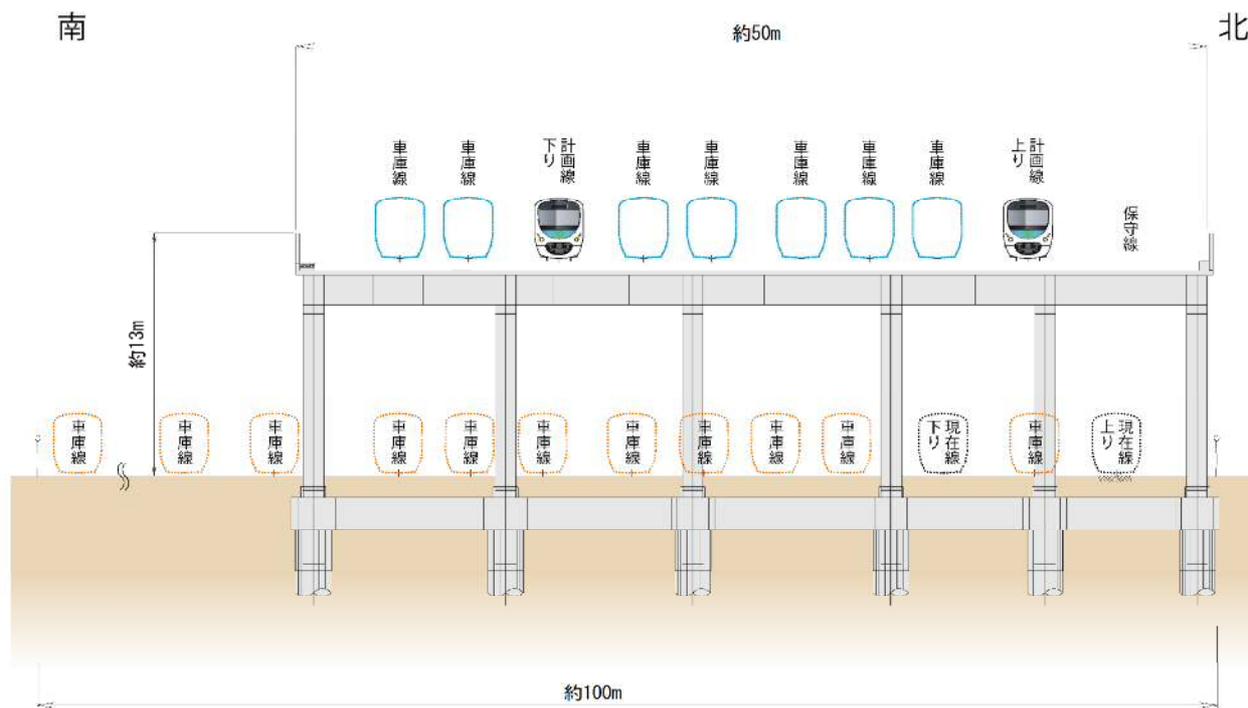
車庫部 (C-C' 断面) 標準断面図
